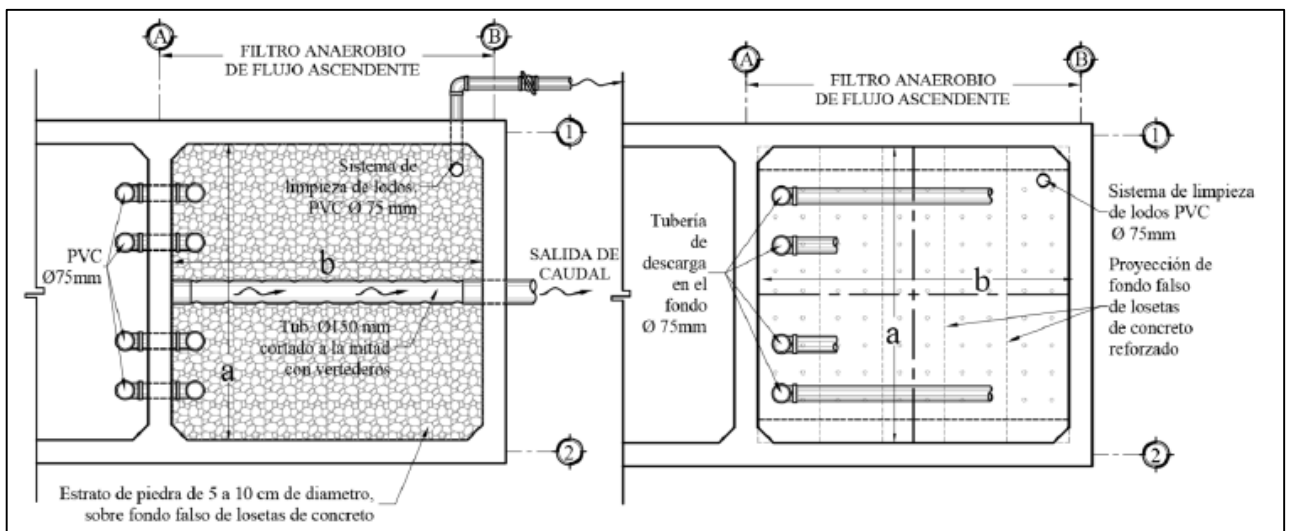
Detalles constructivos de un FAFA –Vista en planta de superficie y fondo
